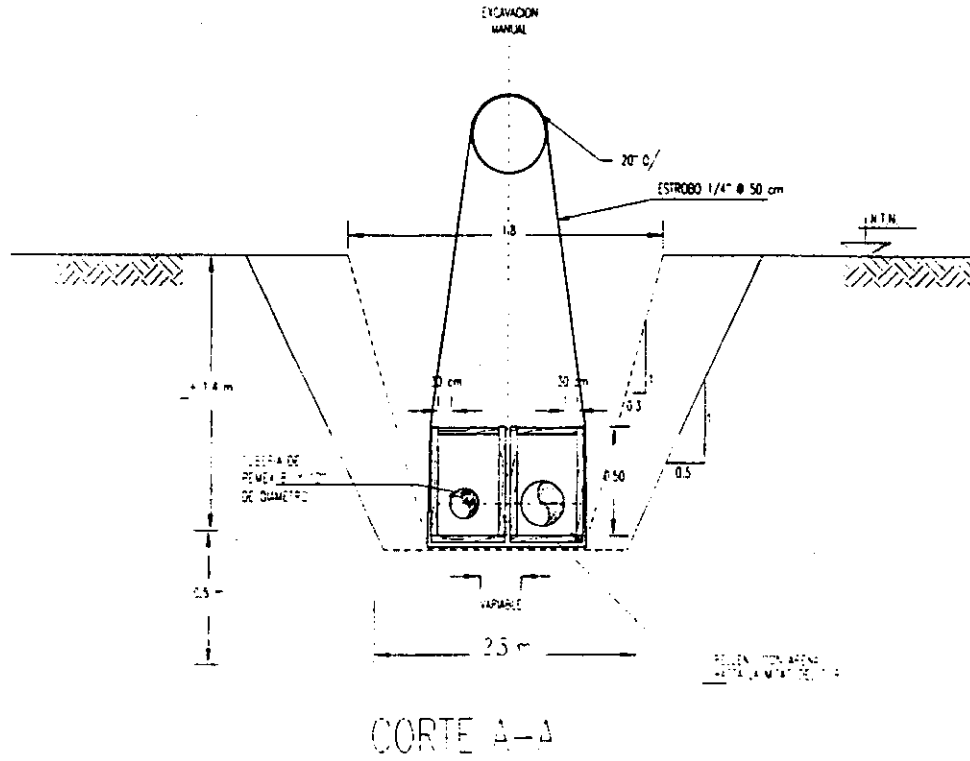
^a ENCOFRADO DE TUBERÍA DE PEMEX
